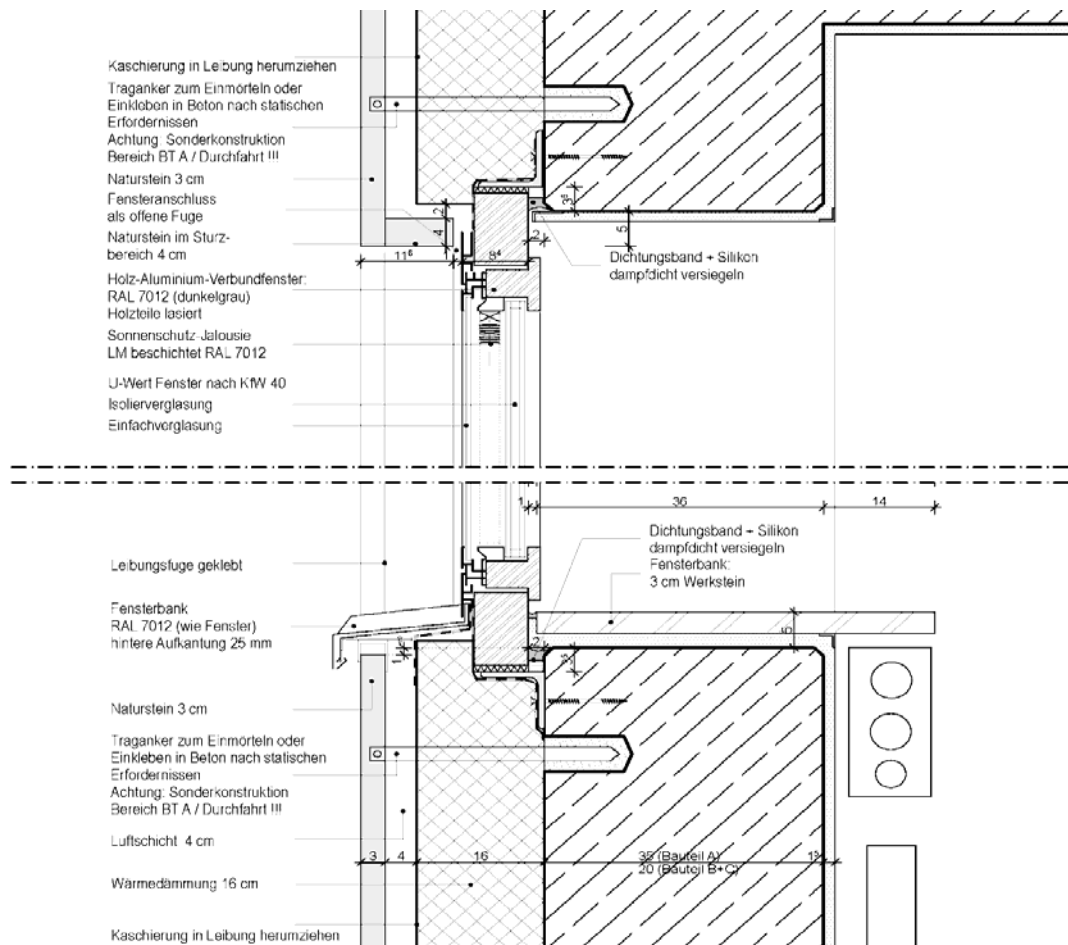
Wandaufbau und Fensteranschluss: Ausführung und Regeldetail
